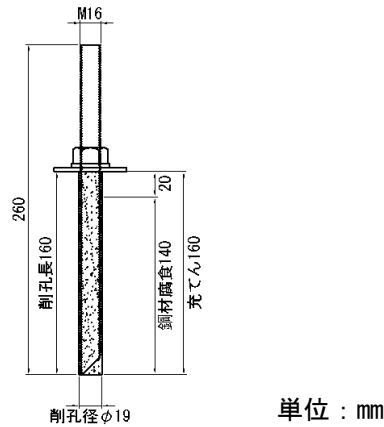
あと施工アンカー施工図 (鋼材腐食)
